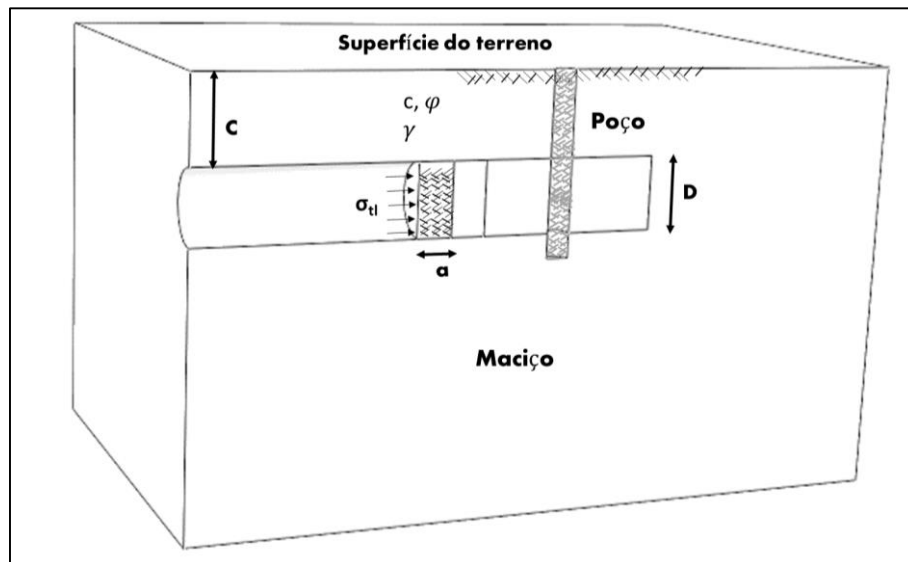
Encontro da frente de escavação com um poço antigo.
